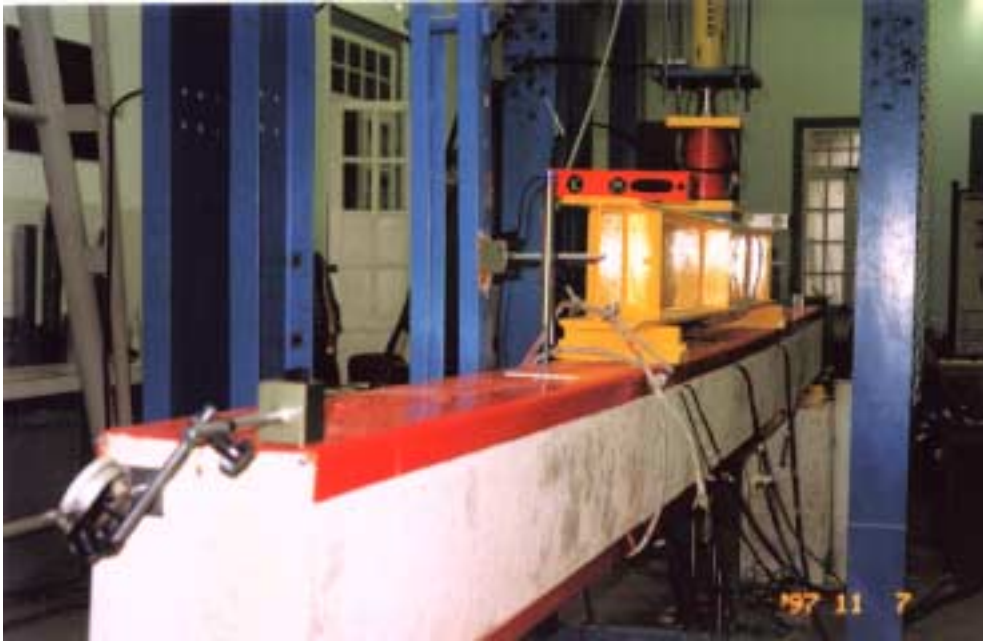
Vista Geral da Viga VD1 Deformada
